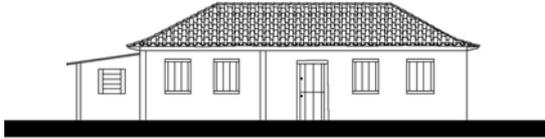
Fachada Anterior (Acervo PROAU/FAU/UnB).
